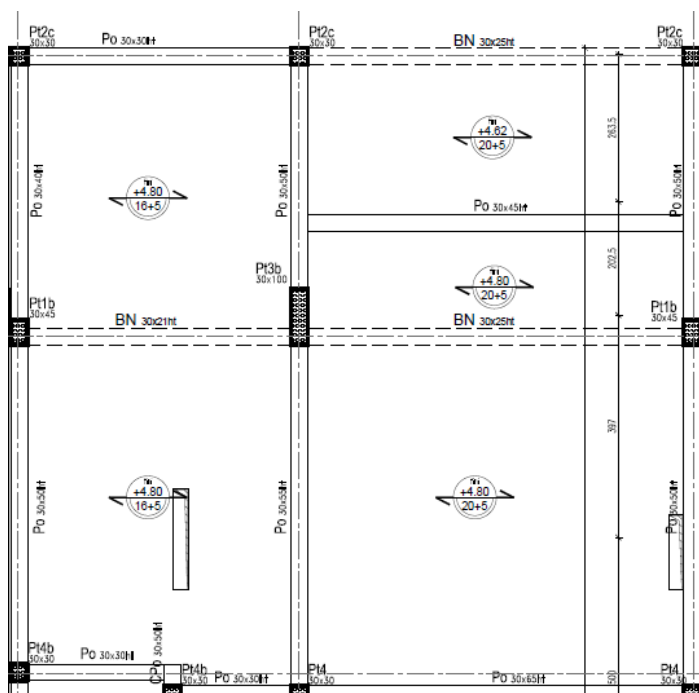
PH RDC JOINT 23 EN POUTRELLES-HOURDIS
